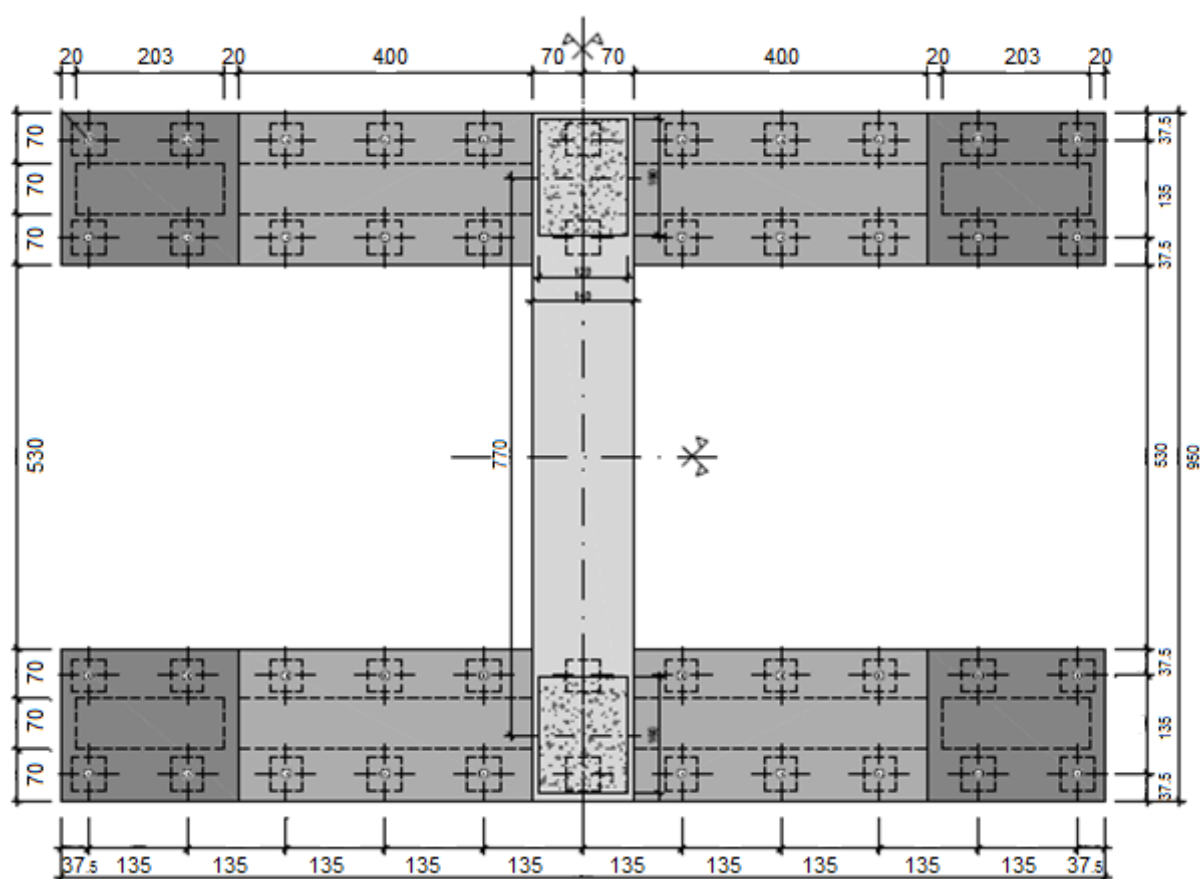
Corte horizontal de um maciço de fundação [10]
